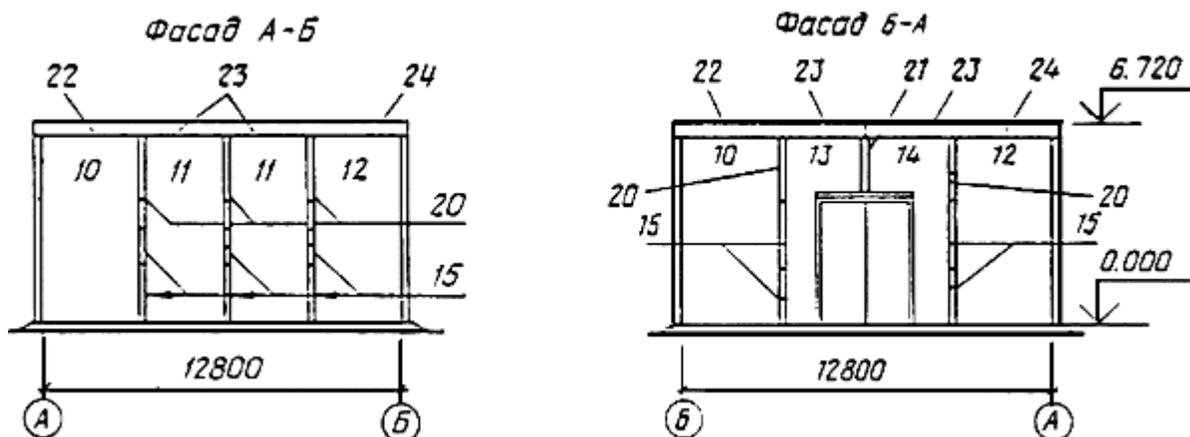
Общий вид здания и схема расположения монтажных элементов (фасад А-Б и Б-А)
